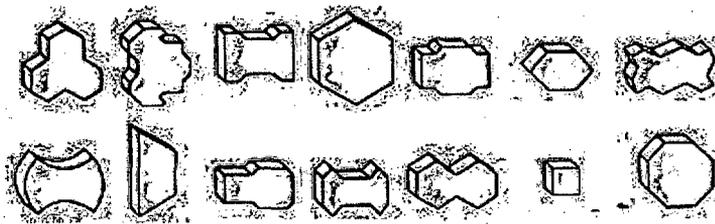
Algunos tipos de unidad de figuras para pavimentos reticulados
